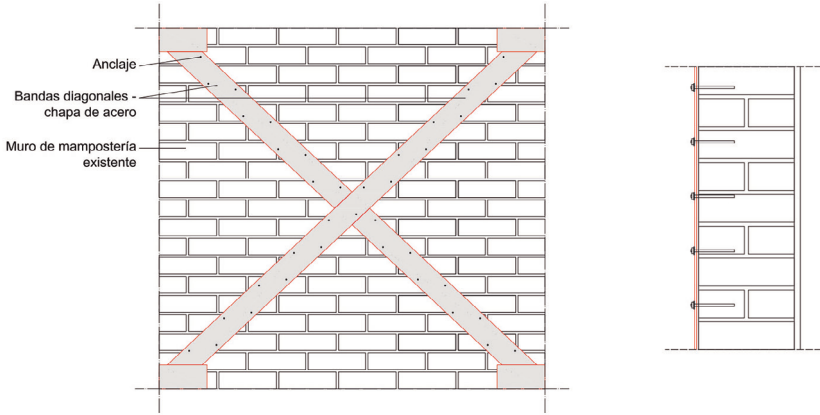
Bandas de acero externas. Esquema y detalle constructivo.
